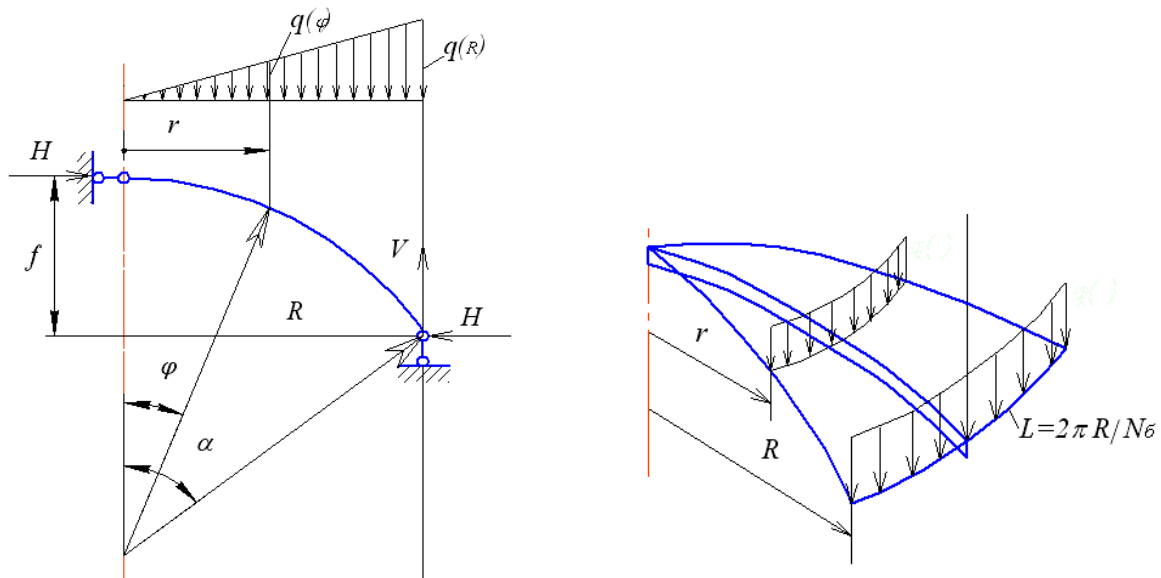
Расчетная схема главной балки сферической крыши вертикального резервуара
